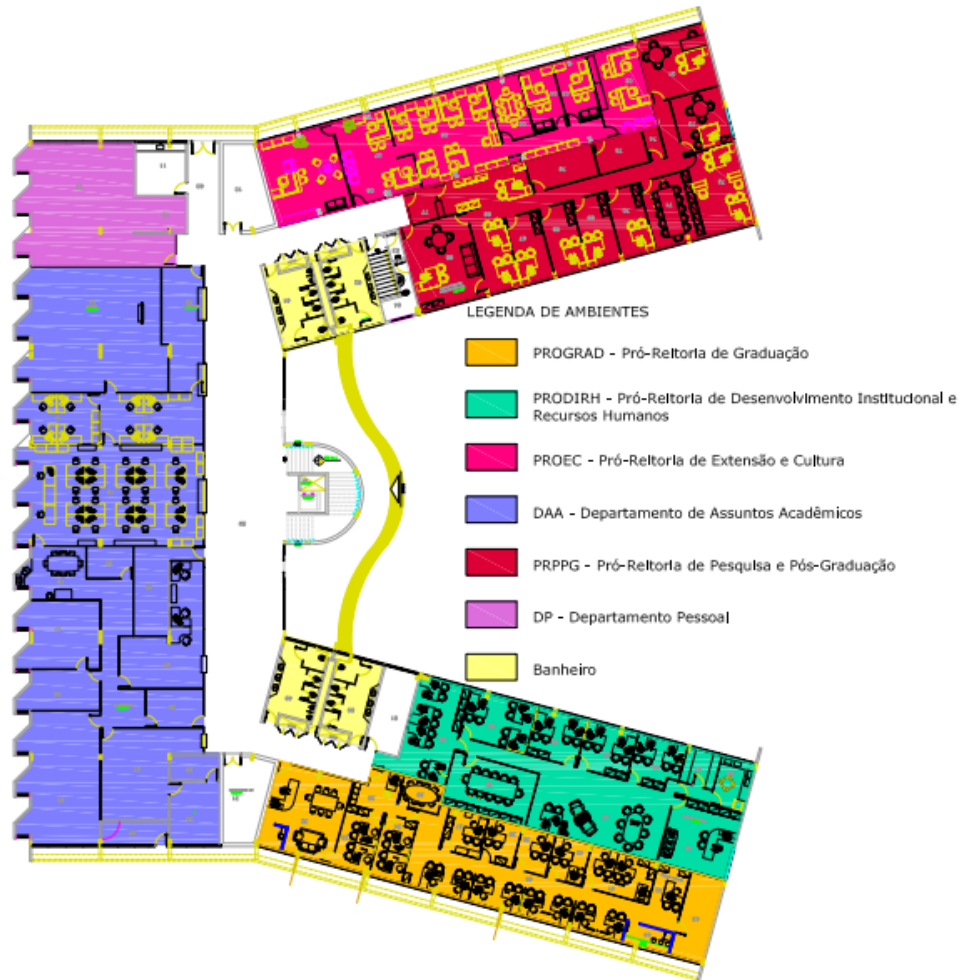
4: Planta baixa da reitoria, pavimento térreo com legenda de ocupação.
